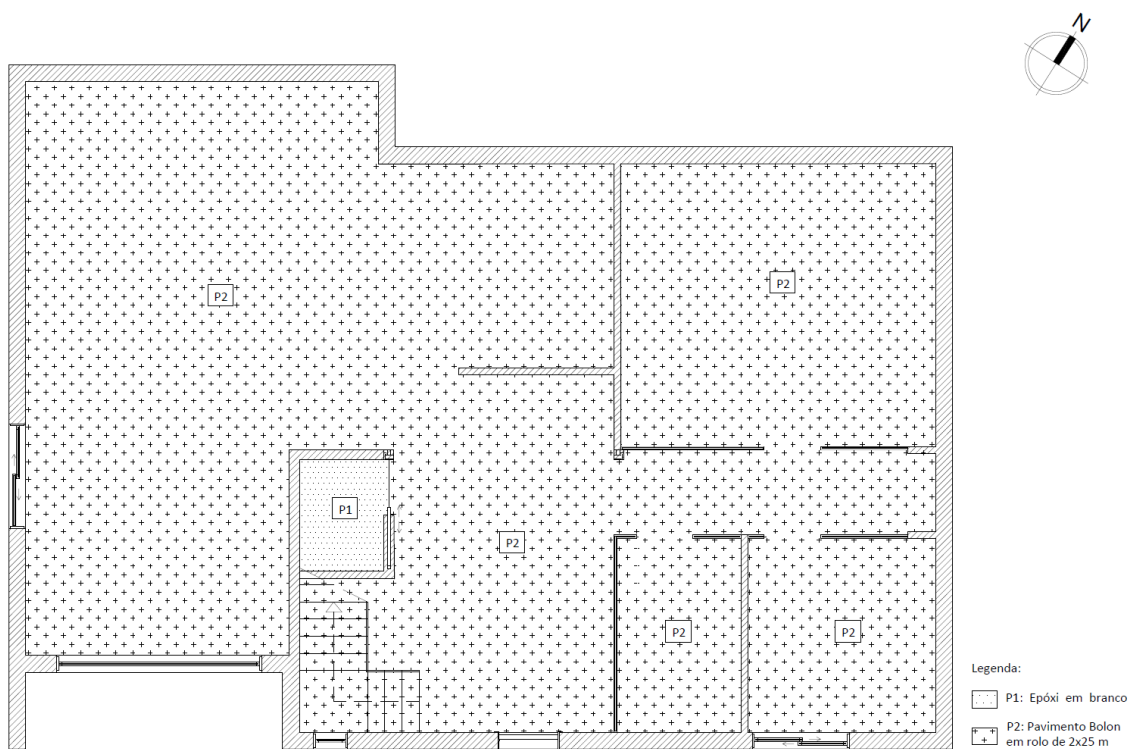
Planta de pavimento piso R/c. Fonte: Marisa Francisco.
